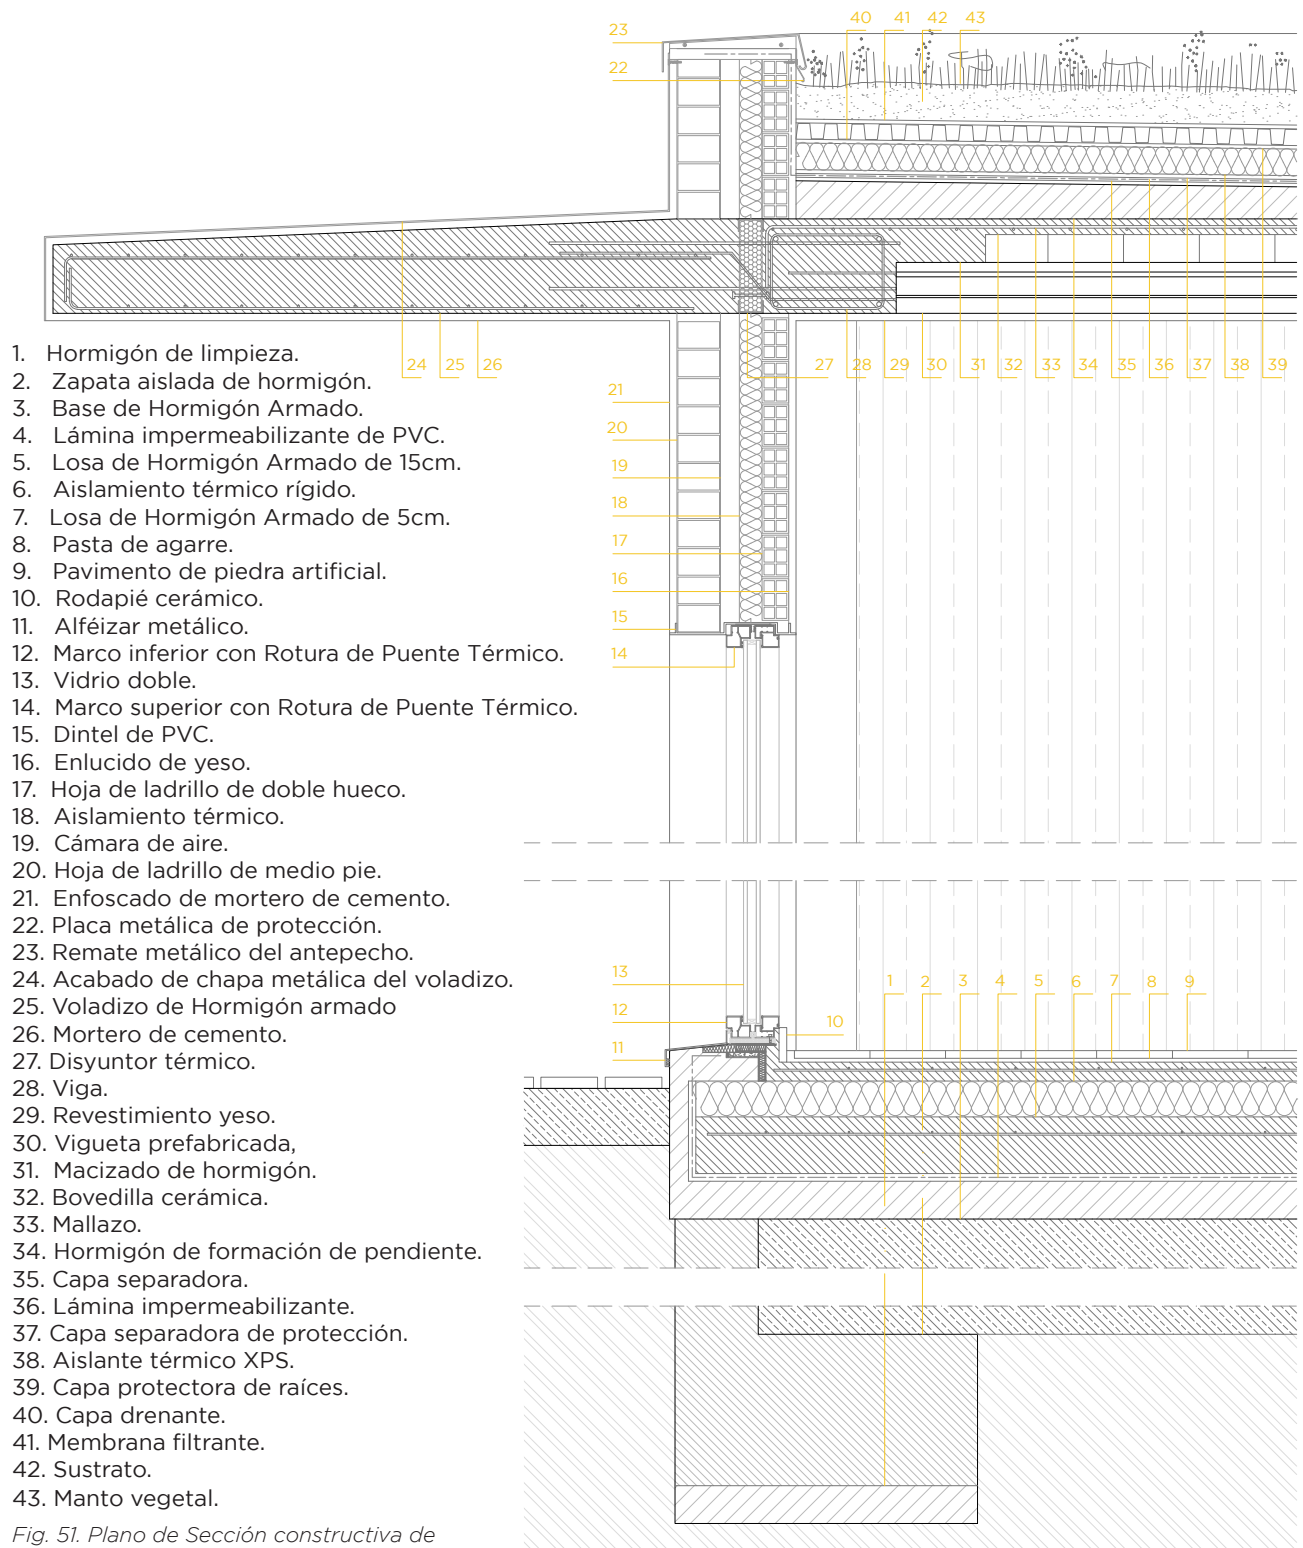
Plano de Sección constructiva de cubierta vegetal invertida.
